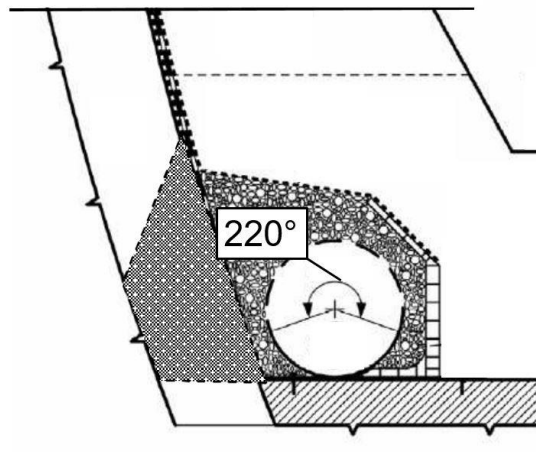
Beispiel Einbau Ulmendrainage - geschlitzte Seite nach oben
